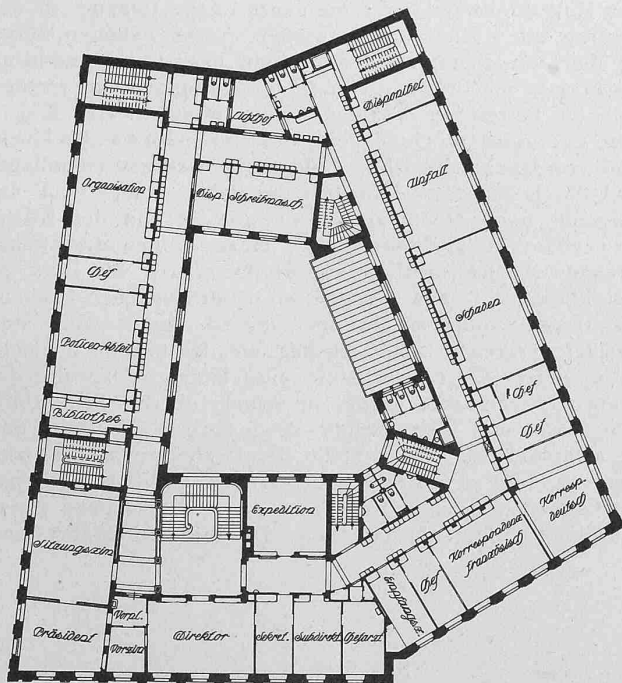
Grundriss vom I. Stock. — 1:600.
